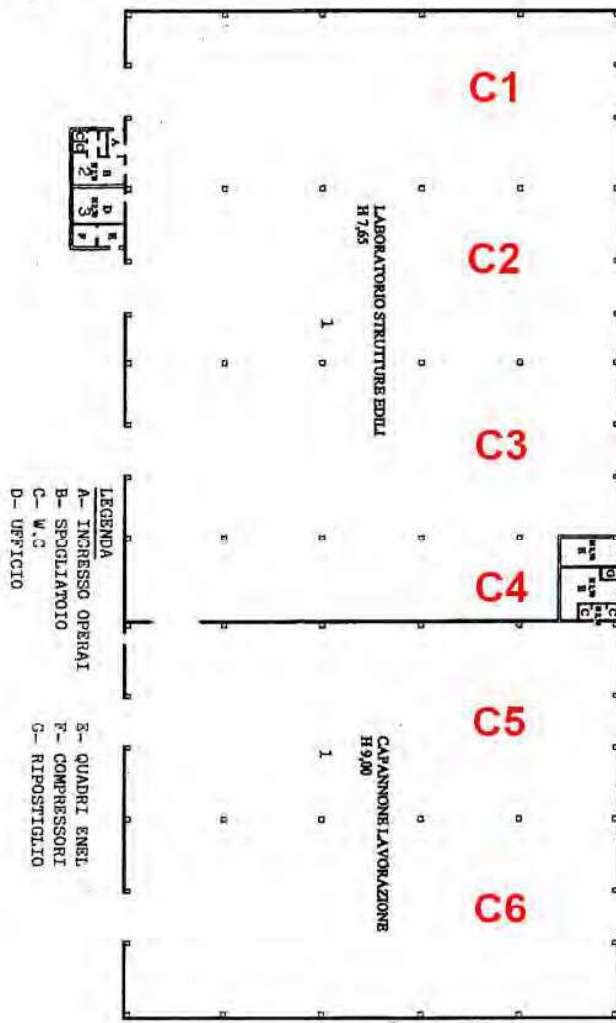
Calto - Capannone C - Planimetria con indicazione locali
